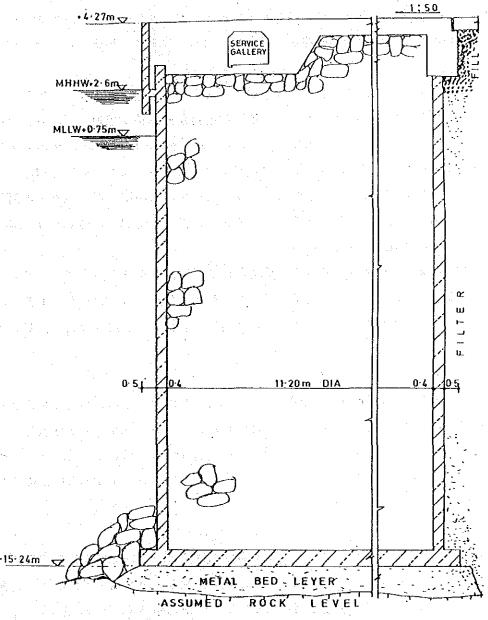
4 - 2 TYPICAL SECTION THROUGH QUAY WALL BERTH 1A
